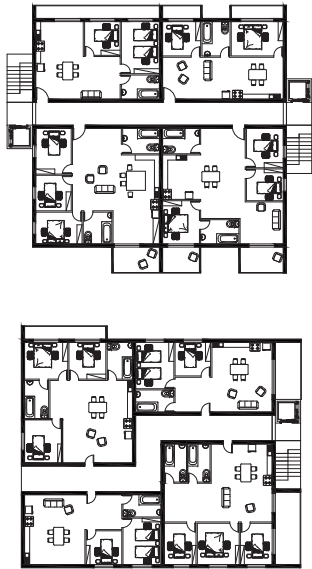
Croquis obra habitada proyecto Edificio Master plan. Fuente: elaboración propia
